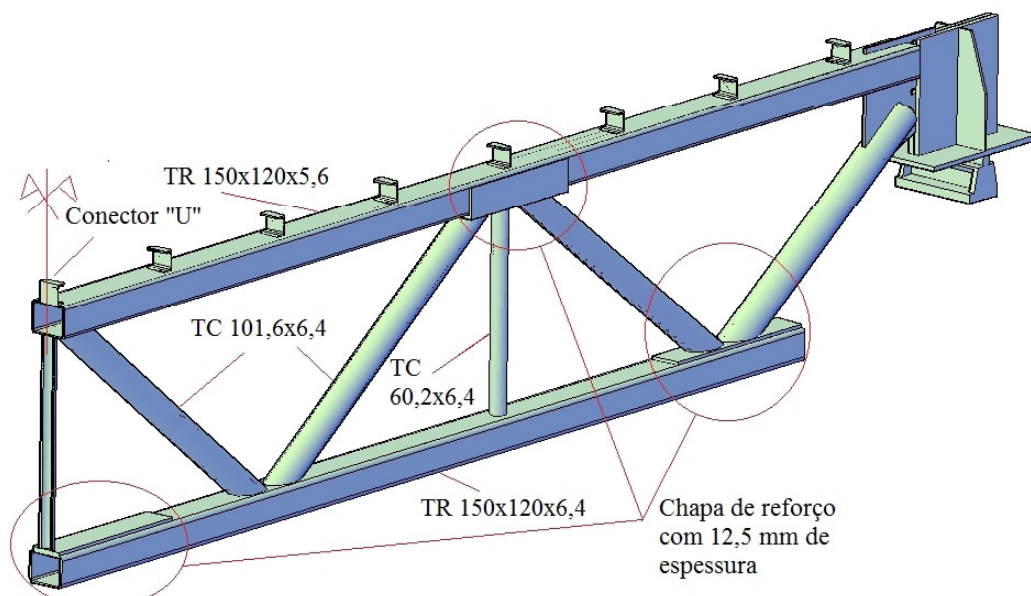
Vista em perspectiva dos elementos metálicos de metade da treliça
